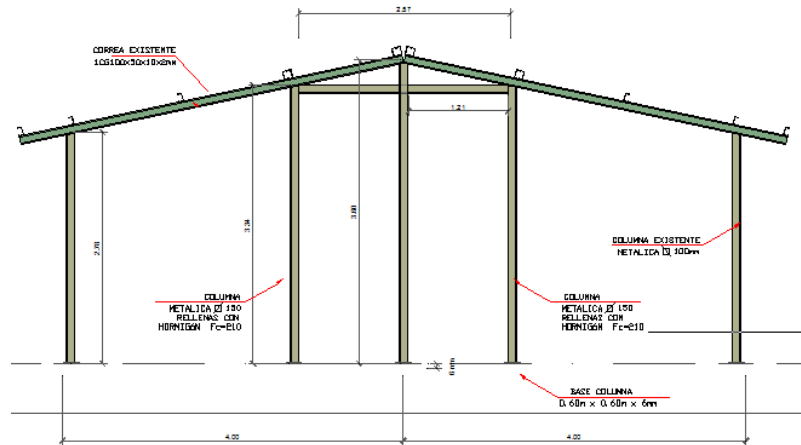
Planos constructivos para reforzamiento propuesto.
